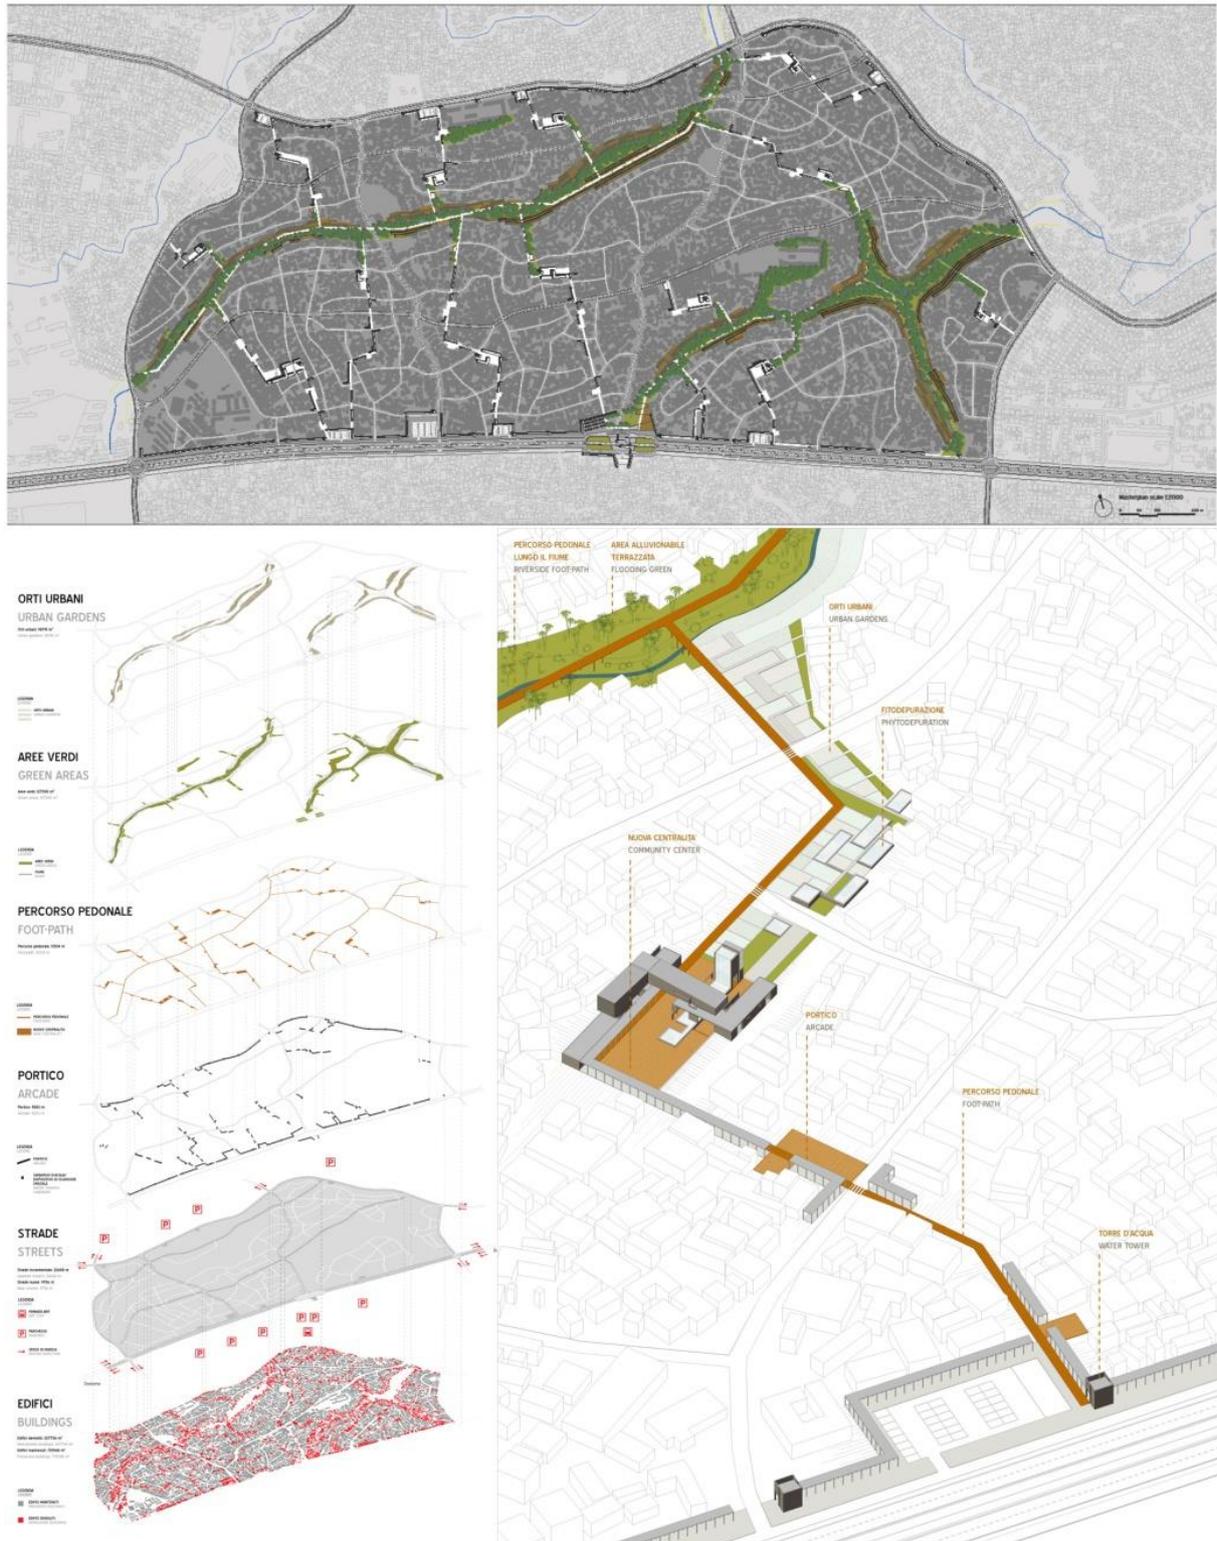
Attrezzare l'informale – planimetria di progetto - Morogoro Road
